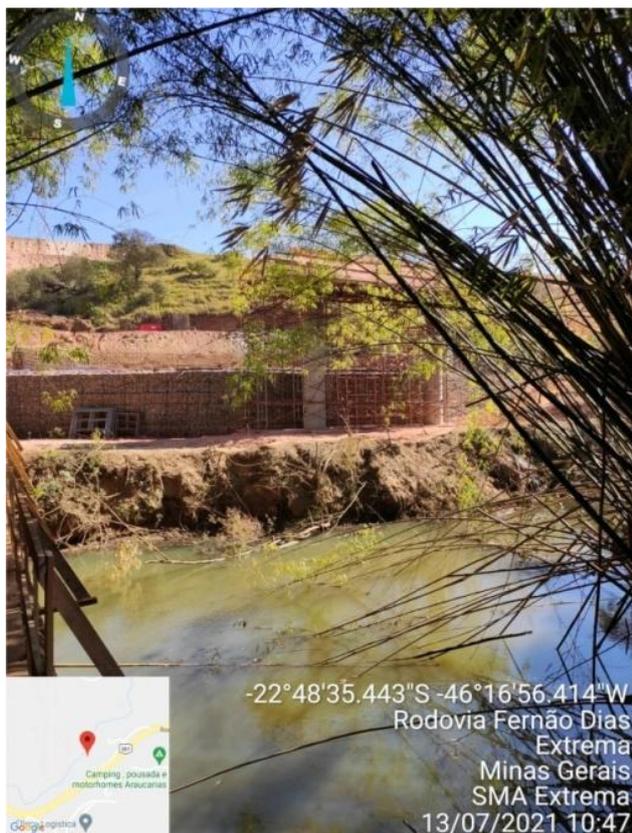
Pilares de sustentação da ponte, instalado nas margens do rio
